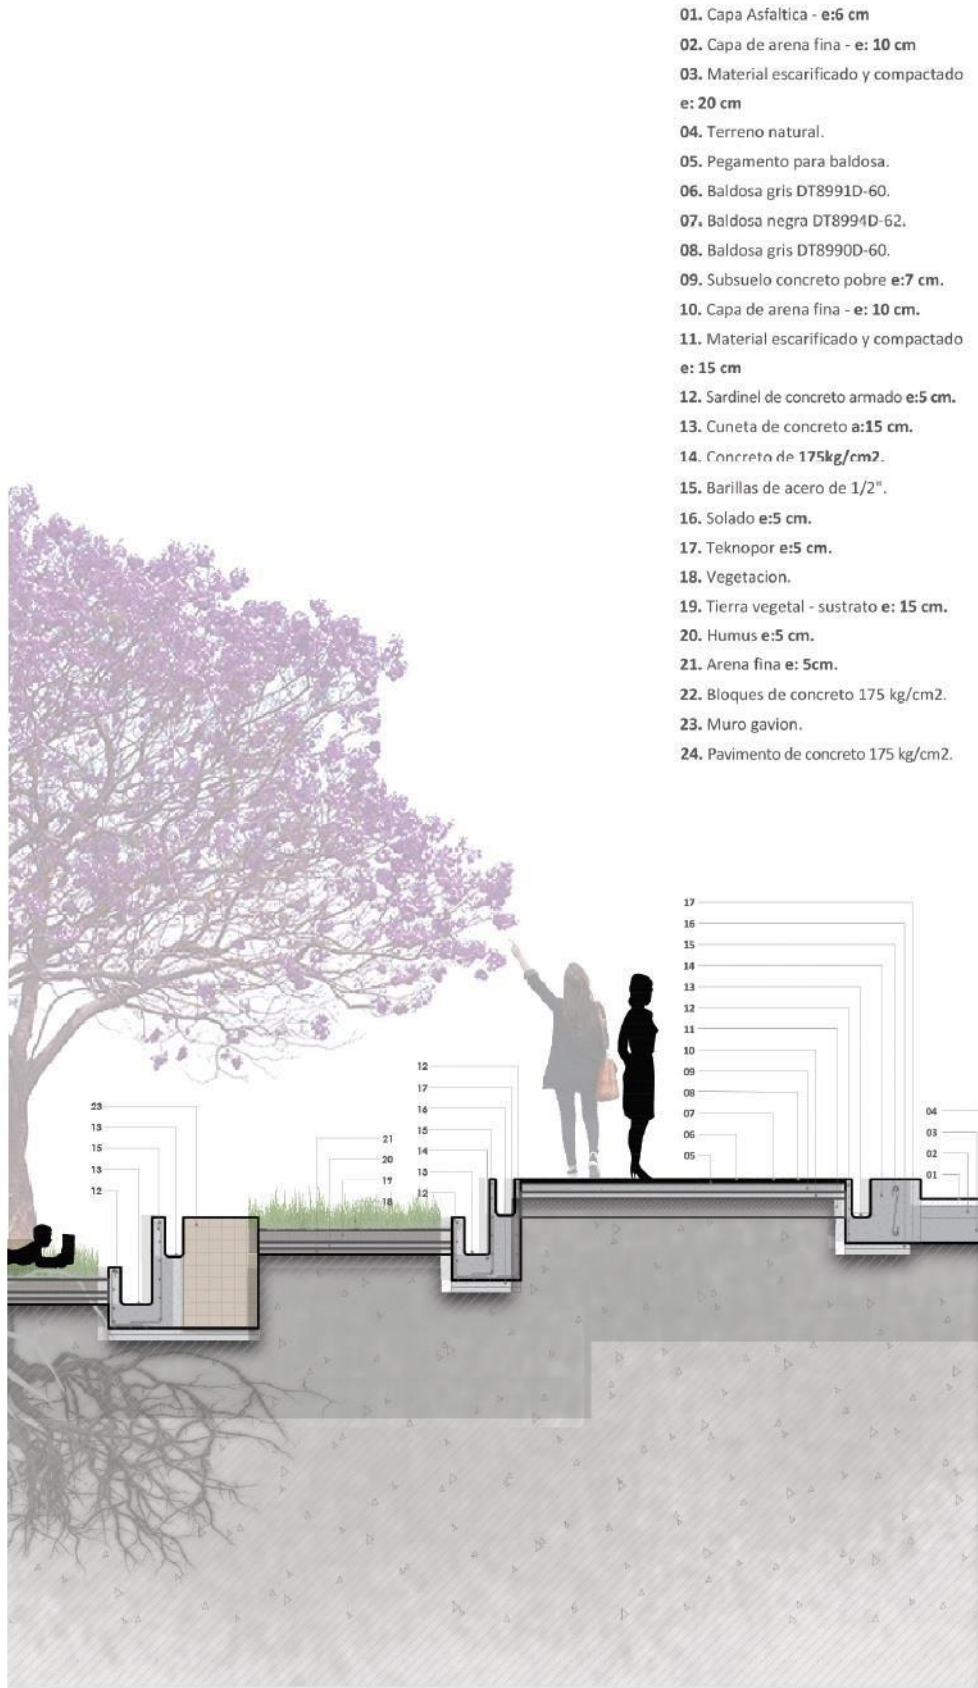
Esquema del Sector 03+ Detalle constructivo 01.
